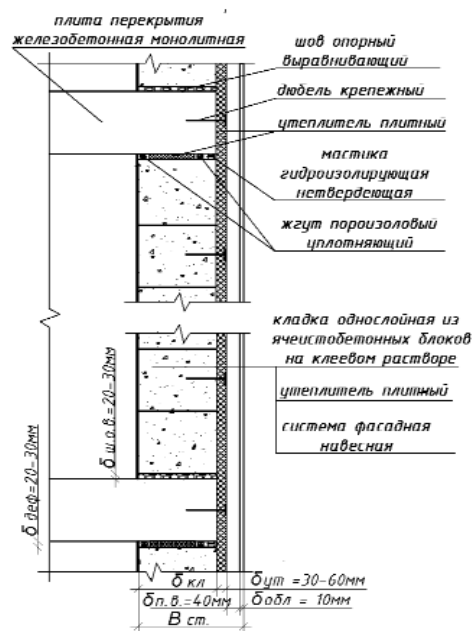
Стена двухслойная из ячеистобетонных блоков и плитного утеплителя с защитно-декоративной облицовкой
